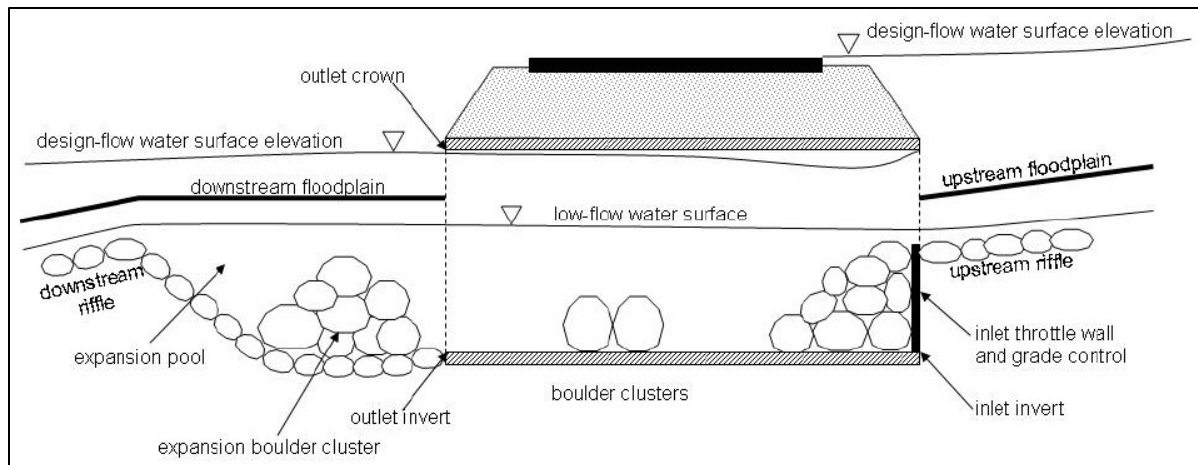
Profil en long type d'un ponceau à refoulement avec mise en place d'une cloison de rétention en amont de l'ouvrage (issu de Parola 2008)
